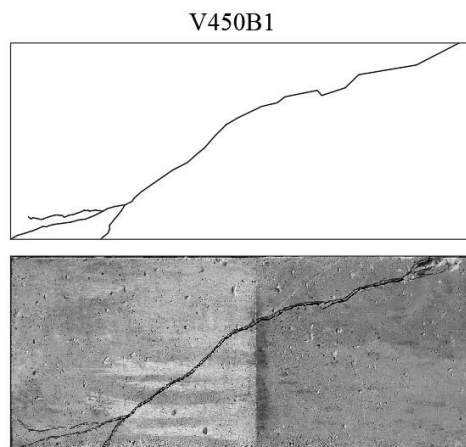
Padrão de fissuração da viga V450B1. Fonte: Autora
